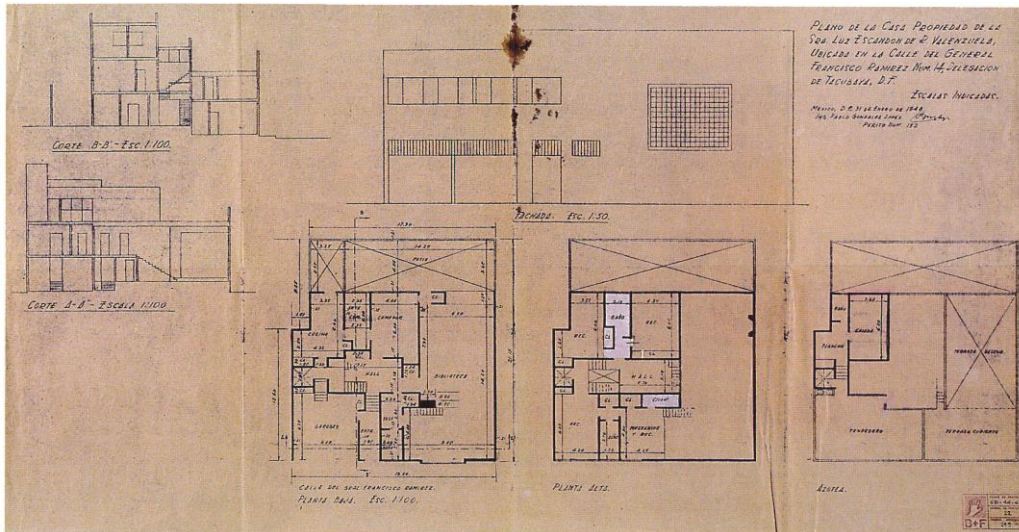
バラガン自邸 平面図, 立面図, 断面図
